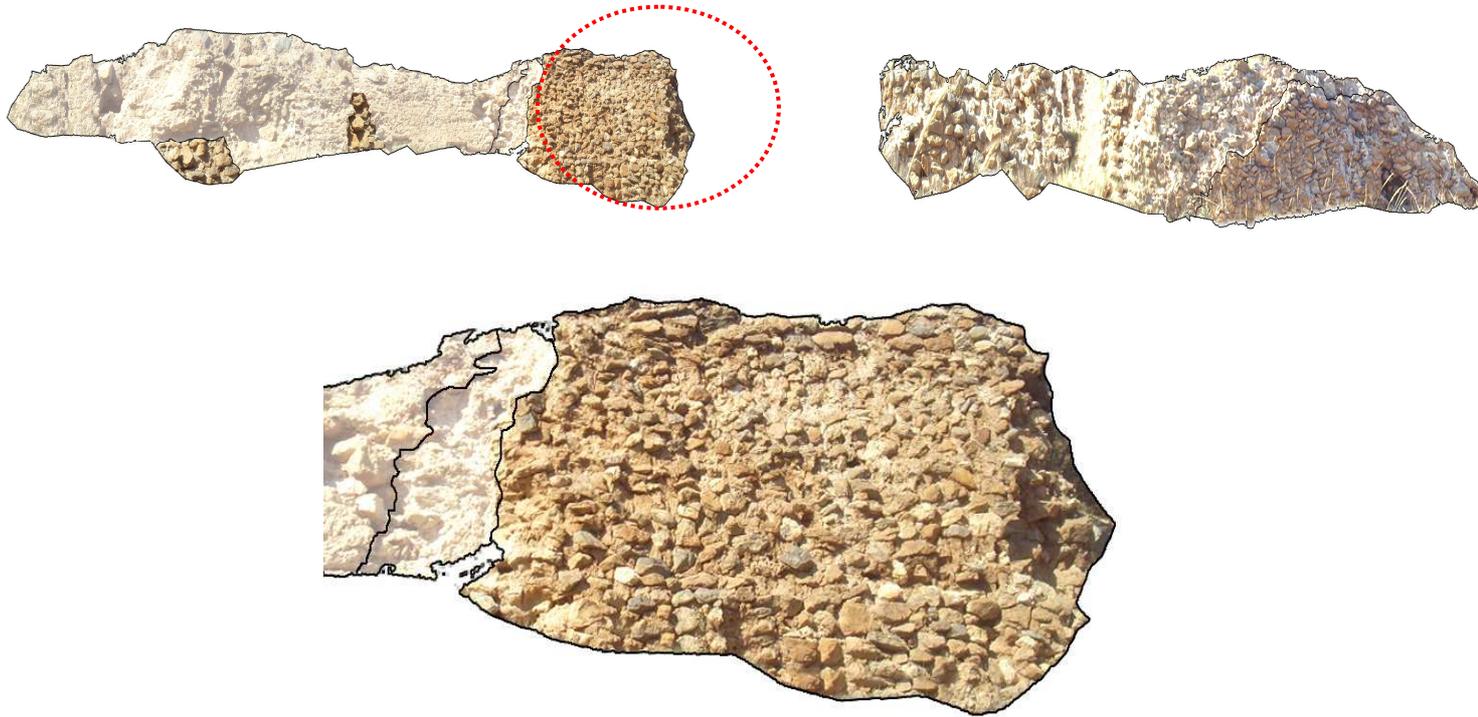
R. Alzados y detalle Cinta muraria Sur
